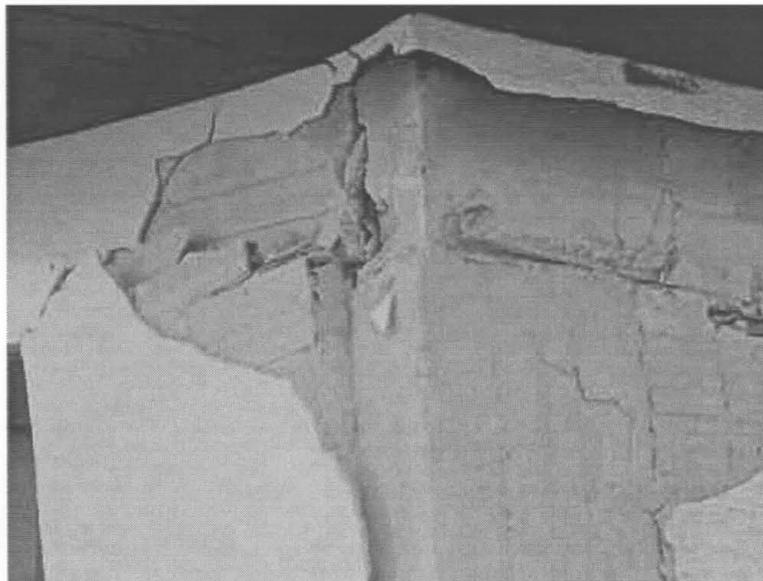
Deficiente detallado del refuerzo, falta de anclaje y de adherencia.
